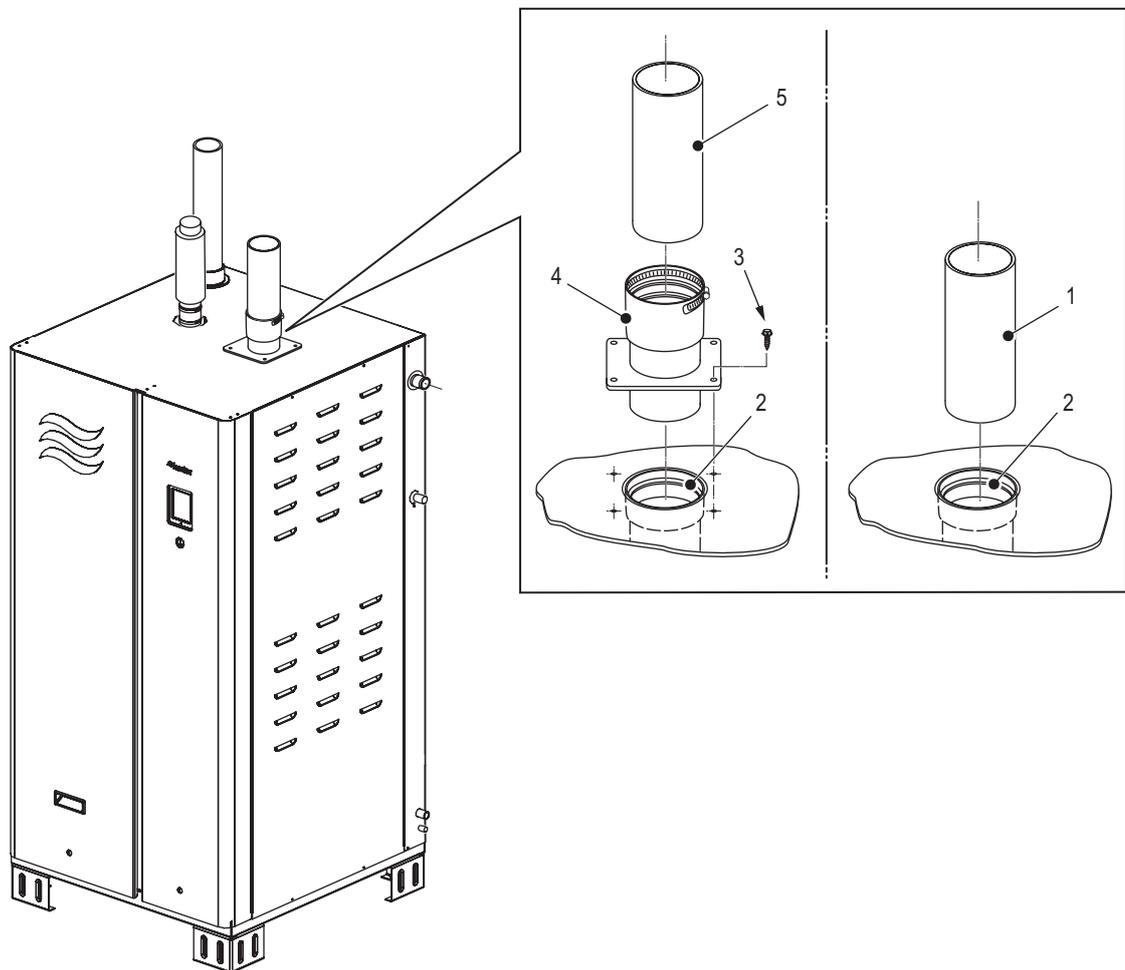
Raccordement de la conduite d'évacuation Condair GS
